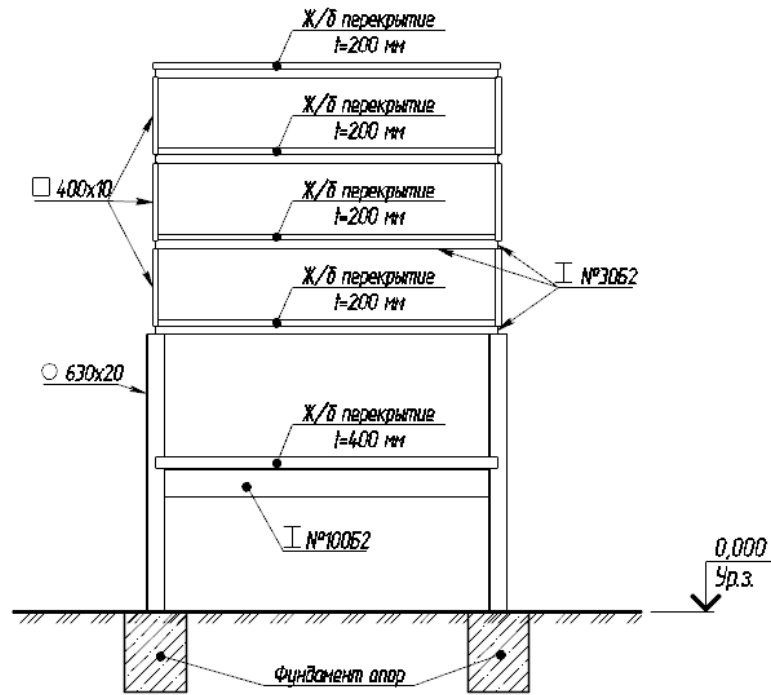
Поперечный разрез предлагаемой конструкции с основными несущими элементами
